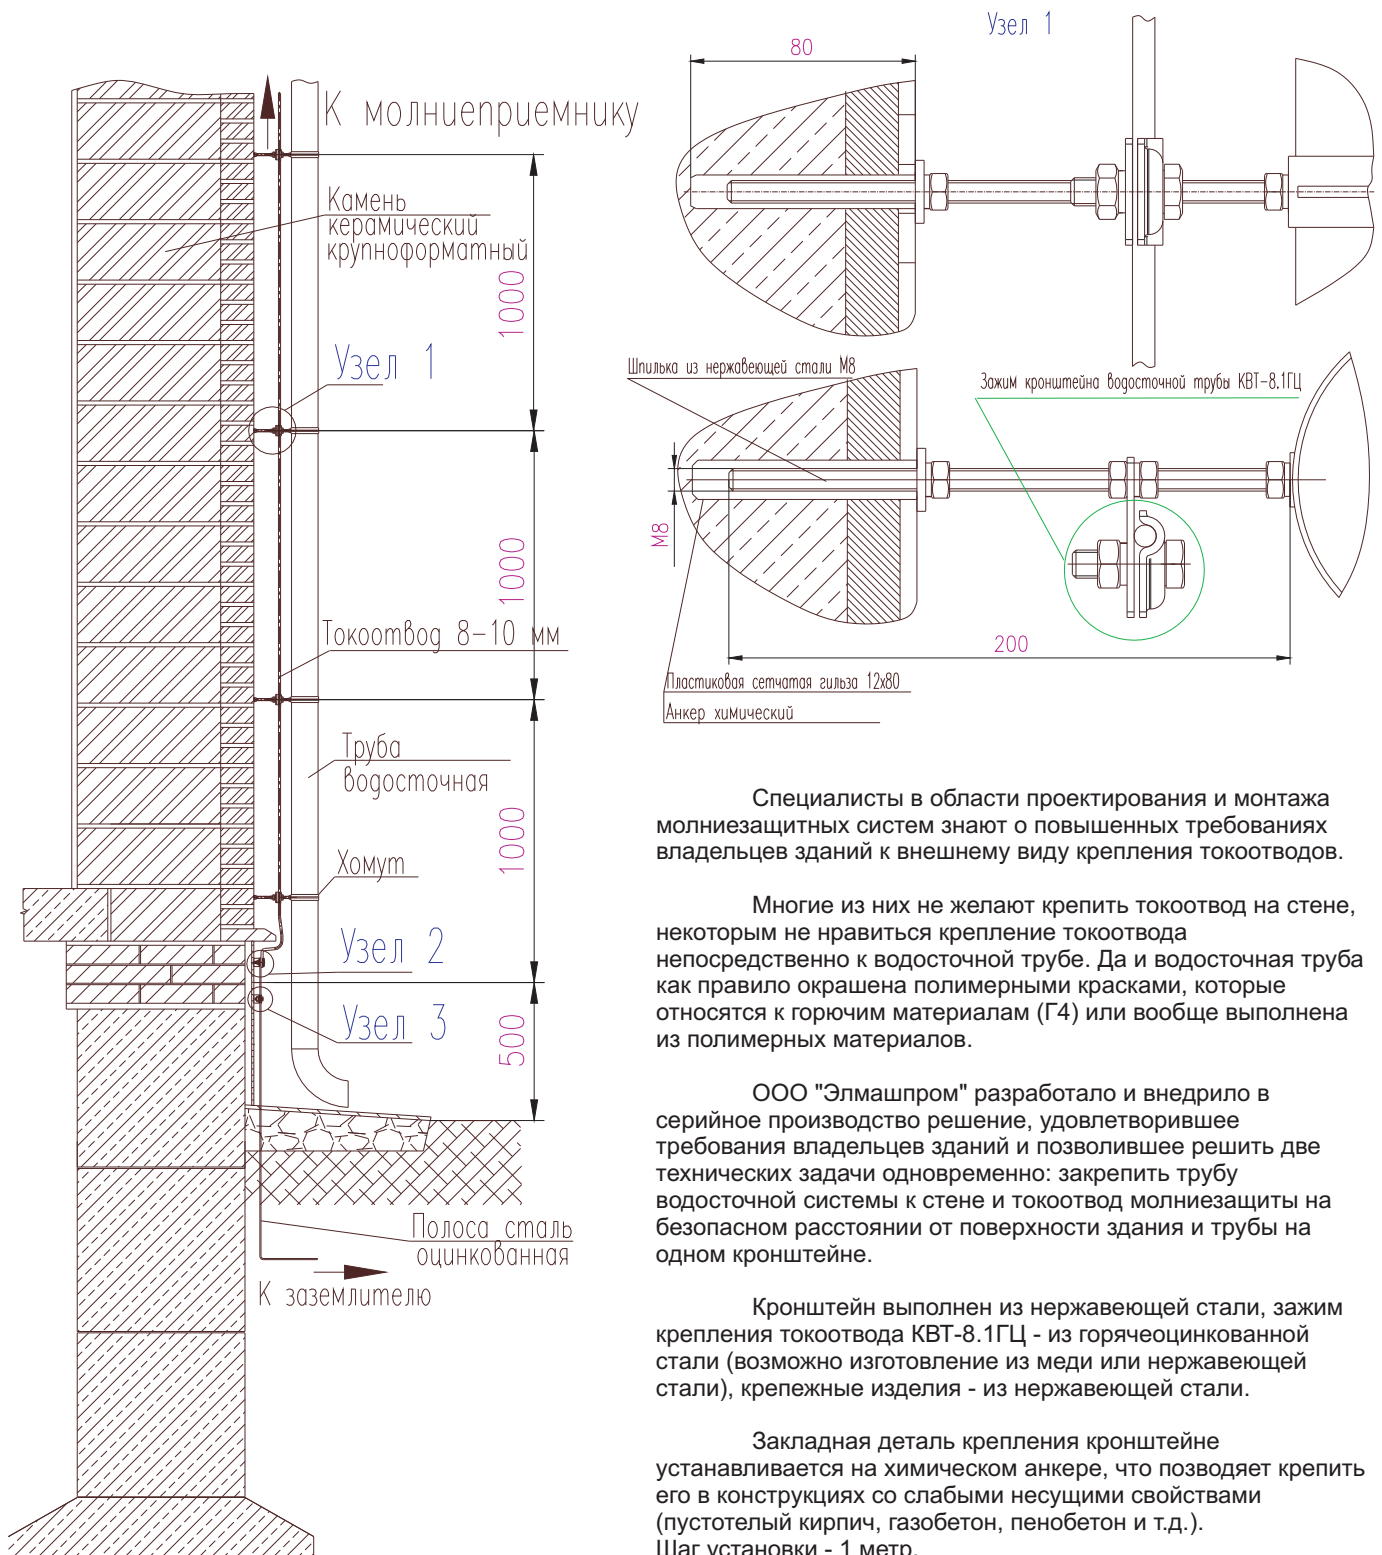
Крепление токоотвода 8-10 мм на фасаде здания
